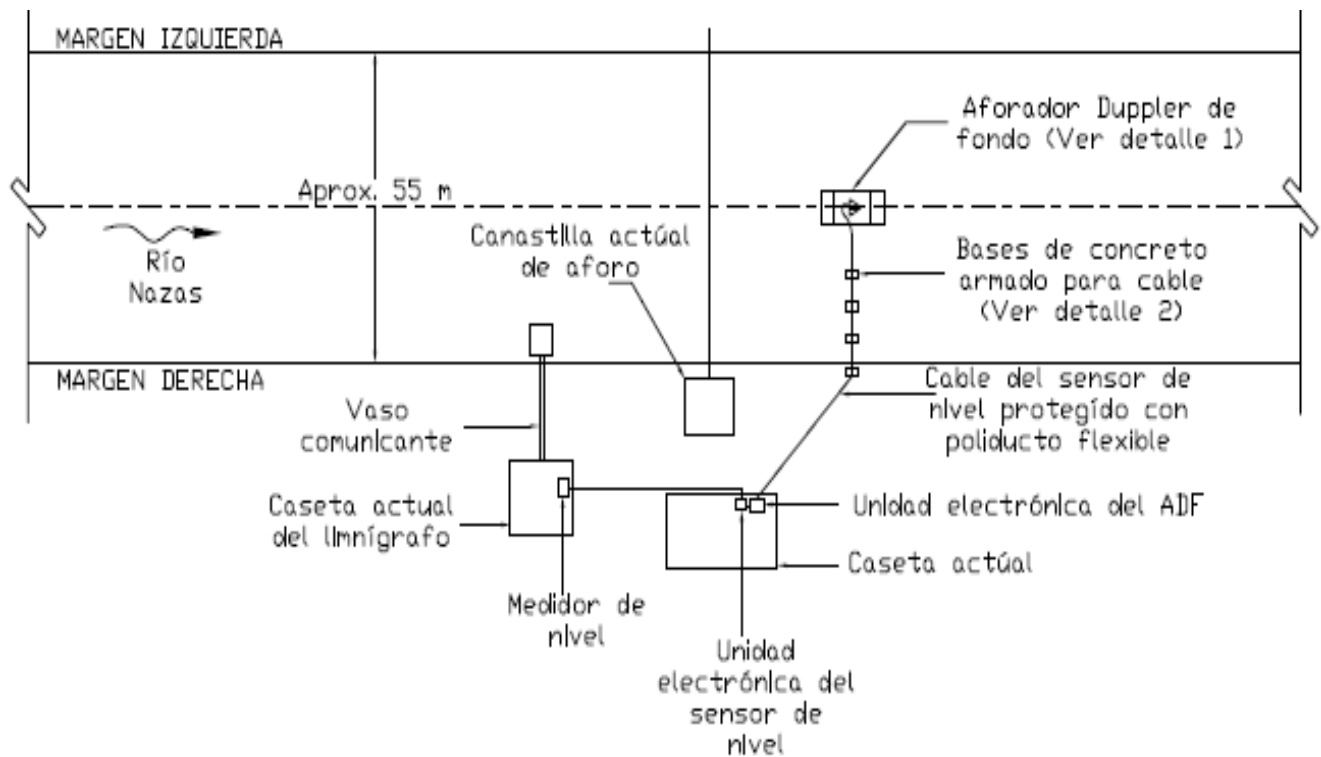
Vista general en planta del sitio de colocación del aforador en "Cañón de Fernández"
